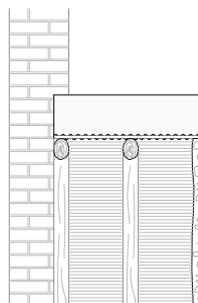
Detalle escalera rollizos de madera Fuente: propia
